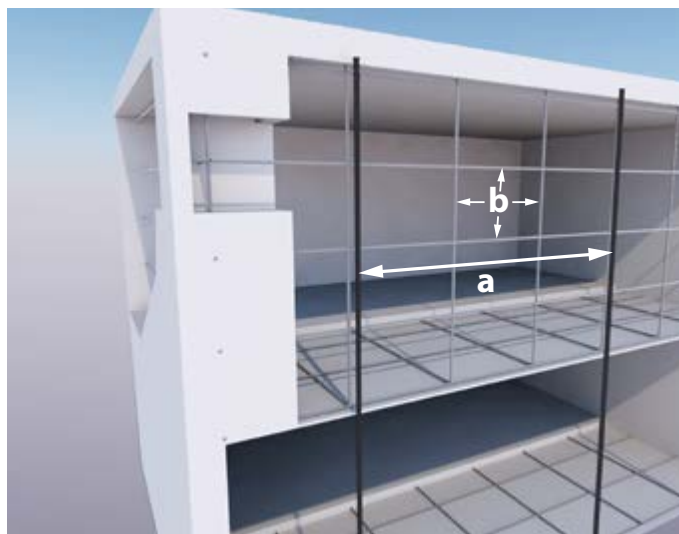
Прокладка токоотводов по арматуре бетонных опор и стен
